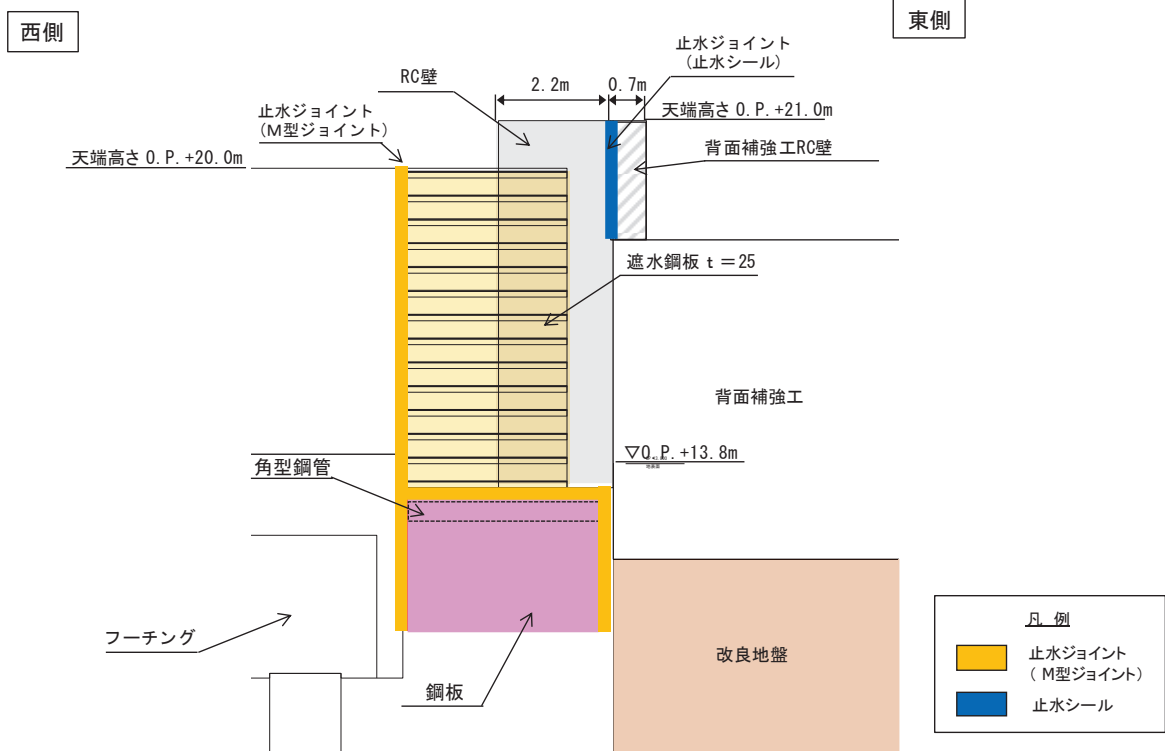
(2) 止水パターン⑪の構造概要(⑪-⑪断面図)
